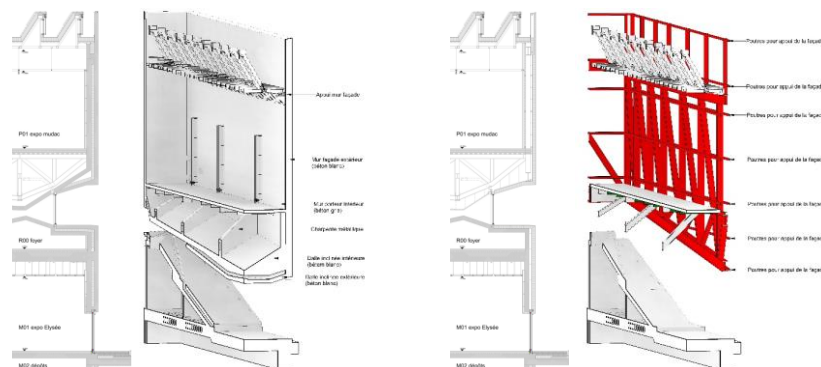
Corte de arquitetura e vista 3D da estrutura com a solução em betão aparente (esquerda) e a solução em estrutura metálica (direita).
